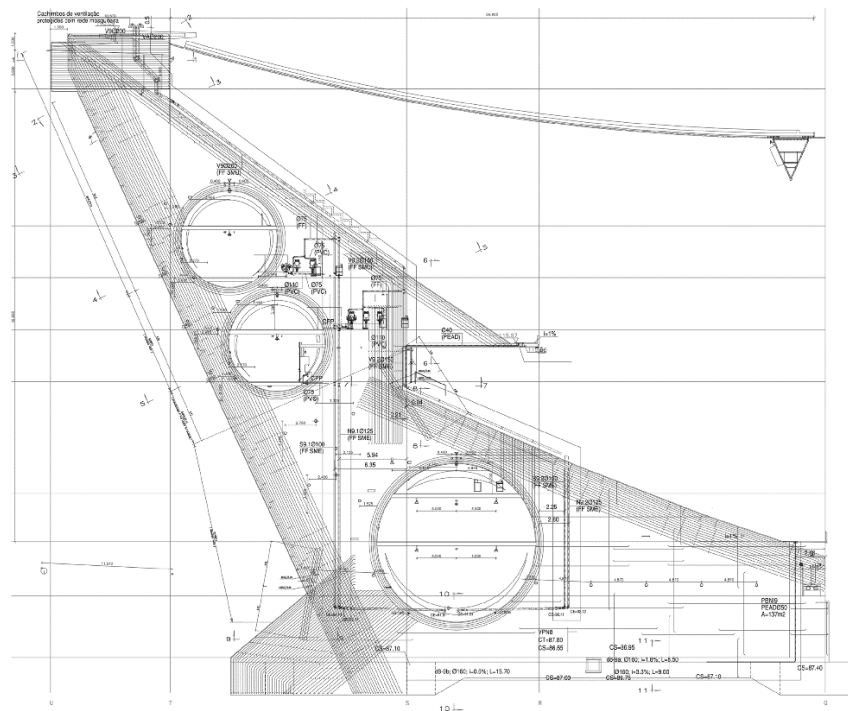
Sistema de gradas en fachada sobre acantilado. Fuente: www.atlasofplaces.com
